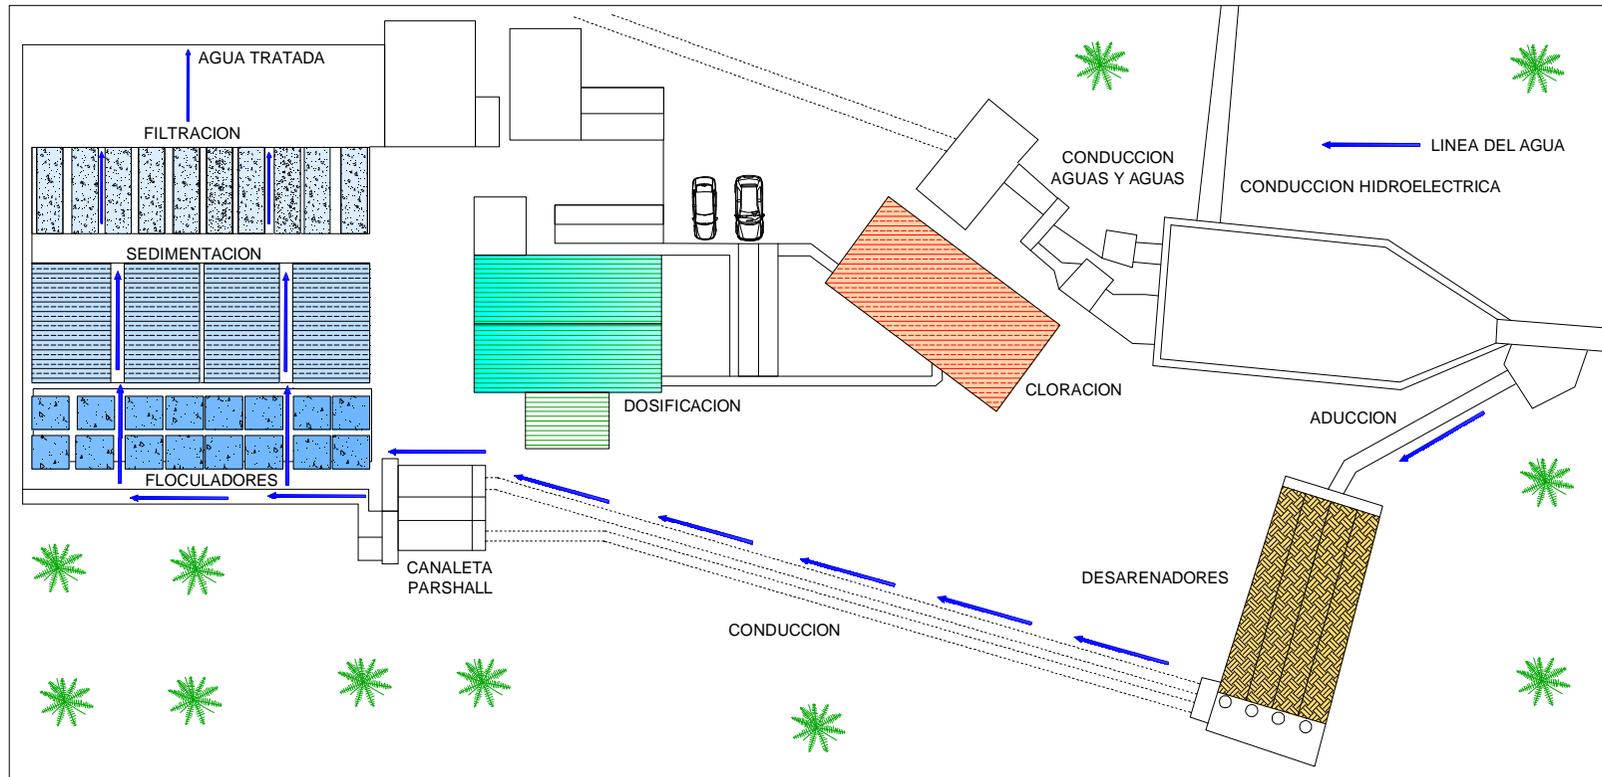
Esquema general del sistema de potabilización de la planta Villa Santa
